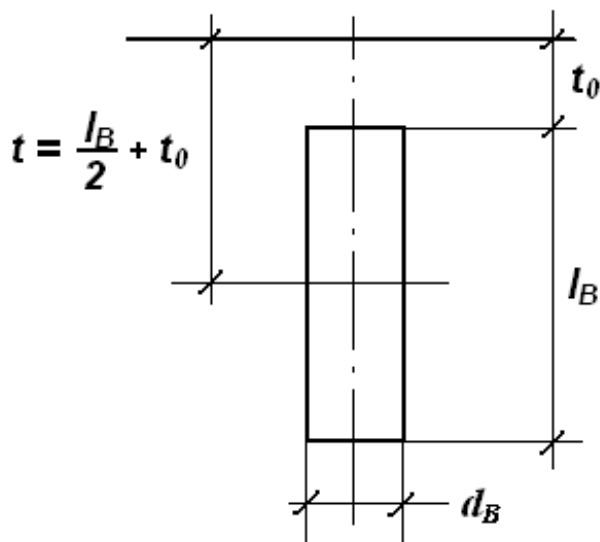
Розрахункова схема для визначення R'_B
